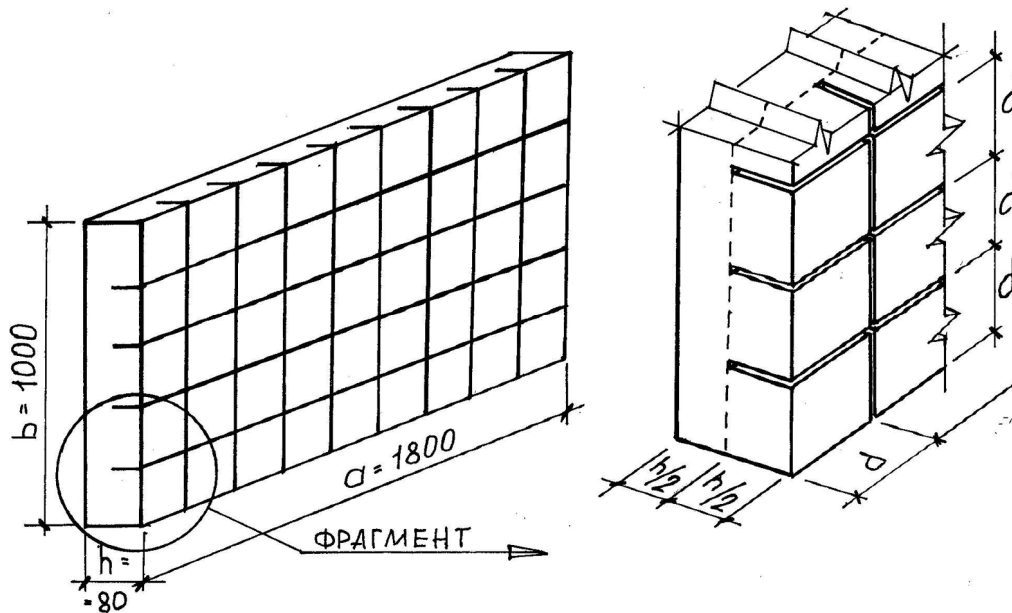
Схема ослабления поперечного сечения гипсобетонной панели
